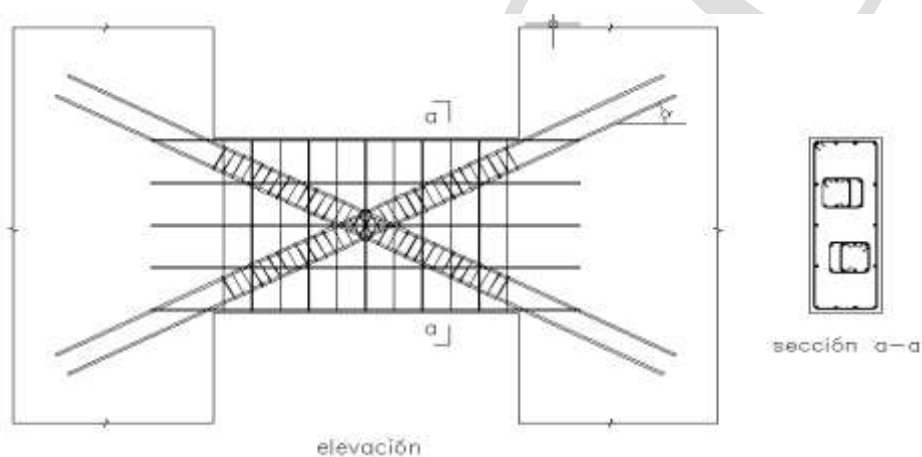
i Refuerzo de vigas de acople
